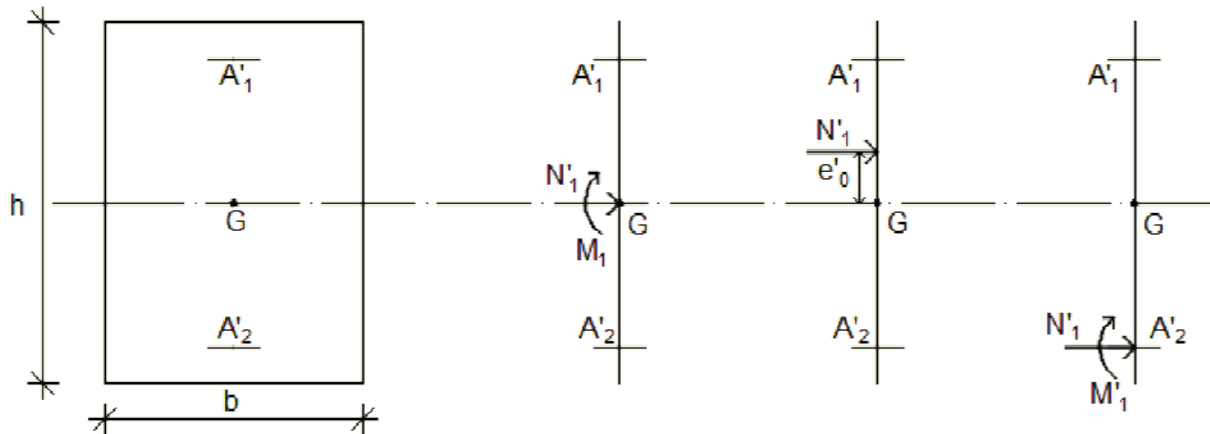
Position de N'_1 , M'_1 et M_1 sur la section transversale.
